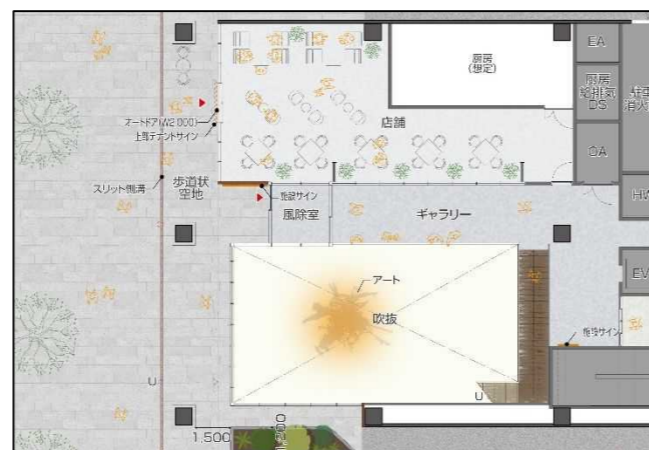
札幌駅前通側 配置・1階平面図（エントランス周辺）
